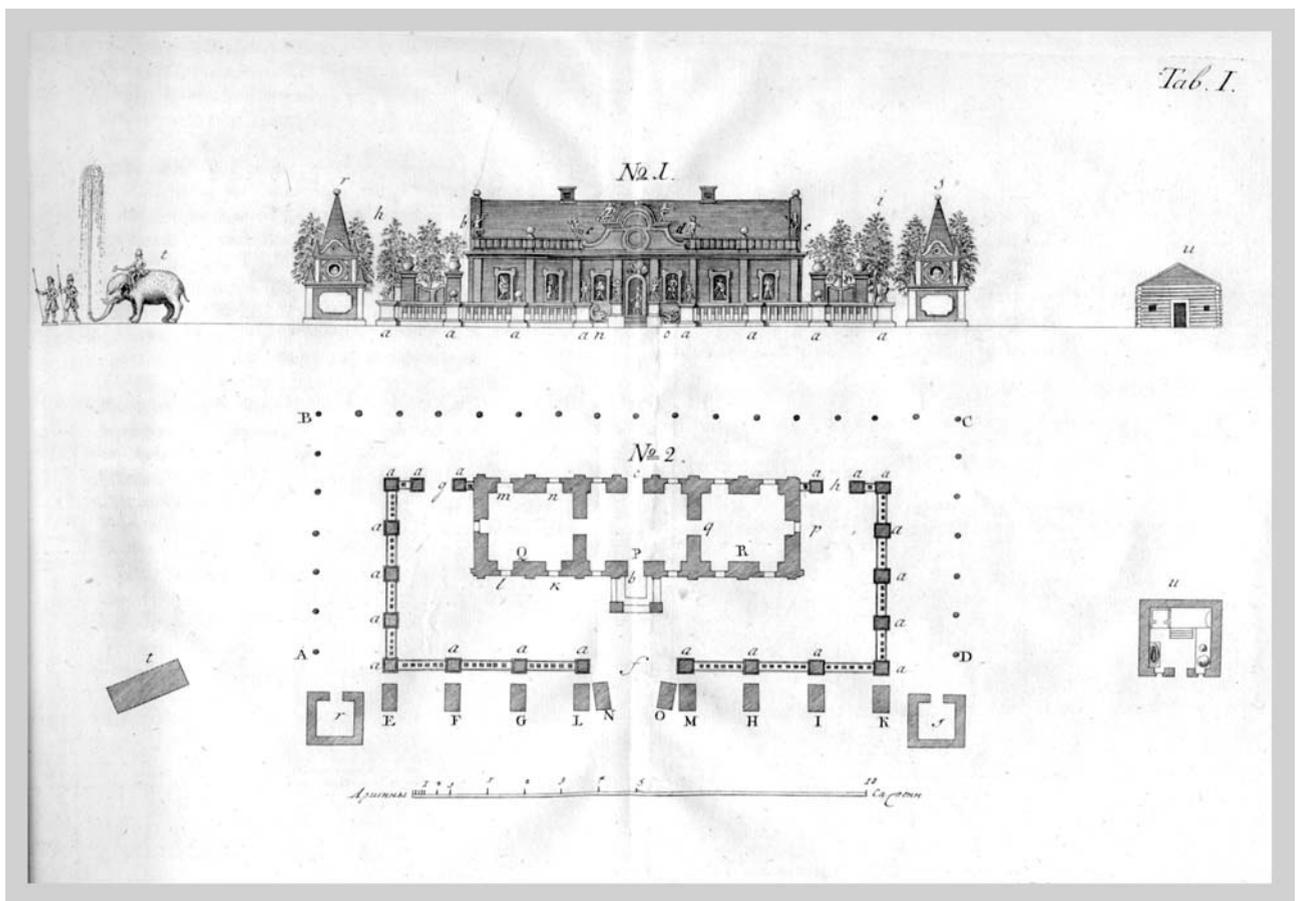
Prospetto e pianta del palazzo di ghiaccio di S. Pietroburgo.
